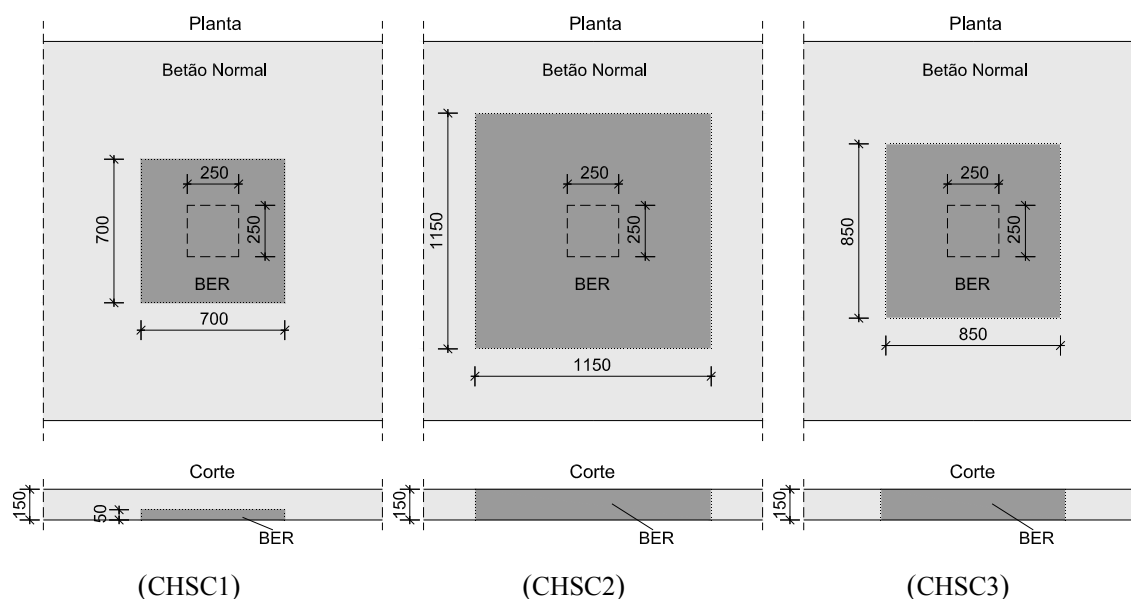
Geometria em planta e em alçado dos modelos ensaiados ao punçoamento cíclico (dimensões em mm).
